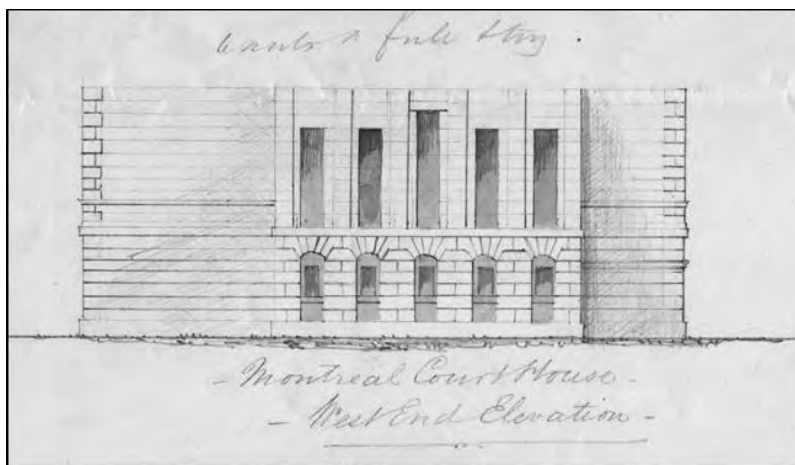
« Montreal Court House, West End Elevation », s,n, s.d., BAC, RG11 vol. 75, no. 12.
